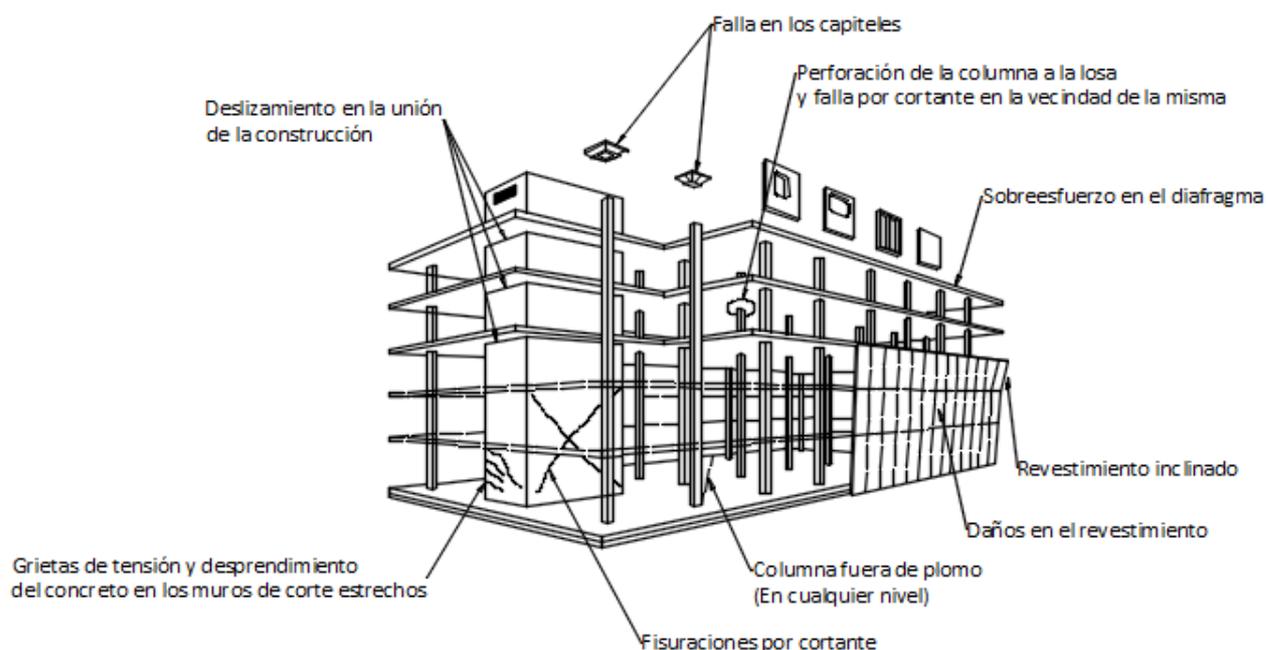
Puntos de inspección para edificaciones con losas de hormigón prefabricado
